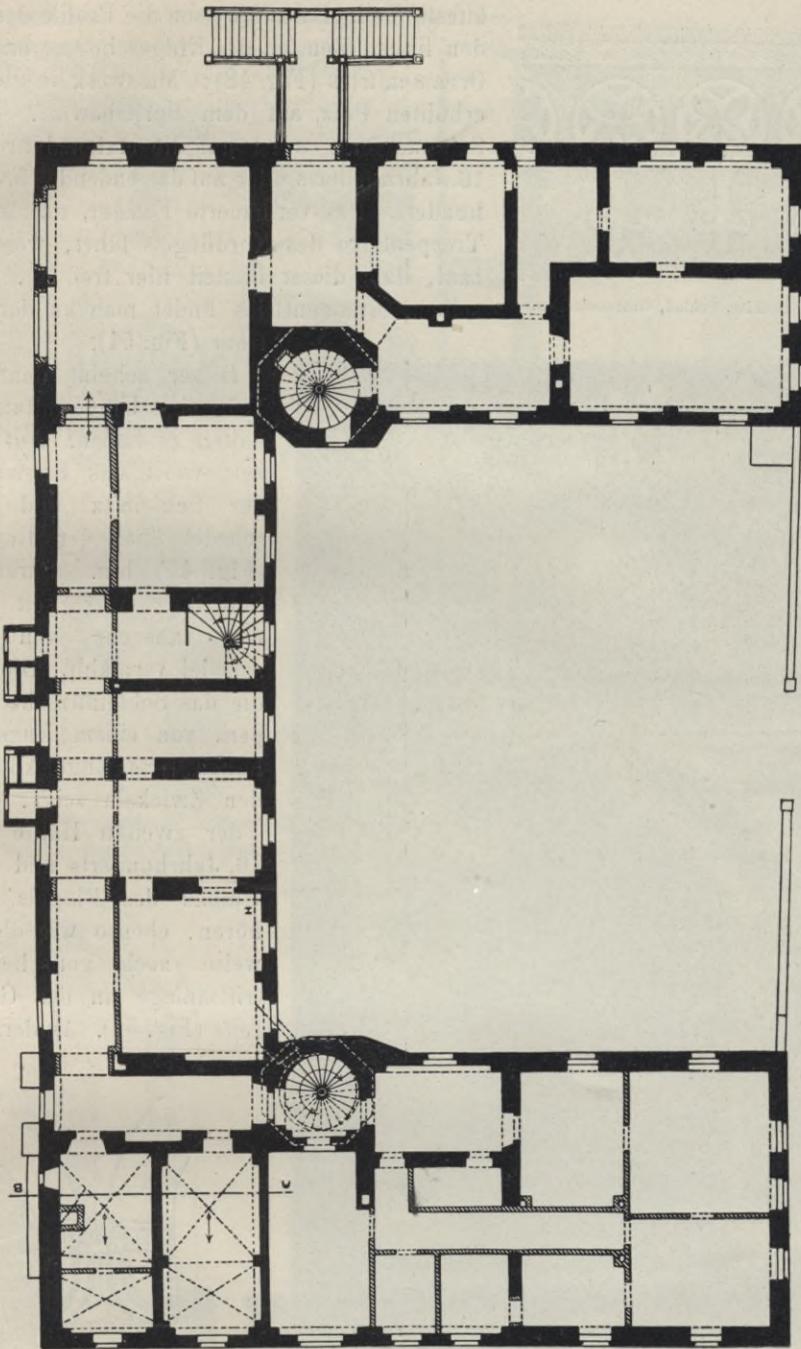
Bornitz, Schloß, Grundriß des ersten Obergeschosses.
